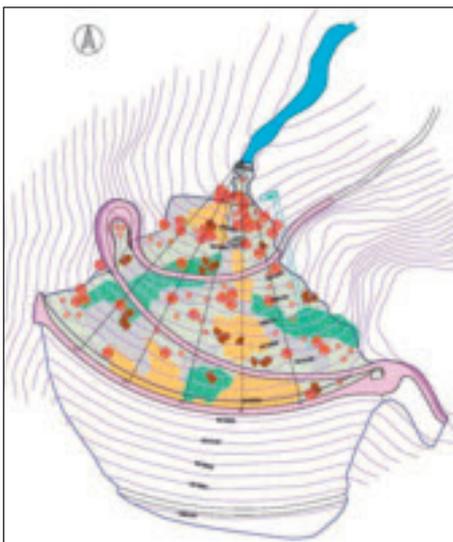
Lageplanausschnitt aus dem Gestaltungsplan des Staudamms (Quelle: Kurz)
